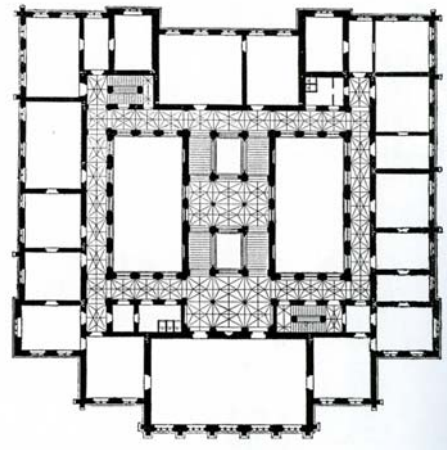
Grundriss des Collegium Novum, erster Stock, 1882-1887
